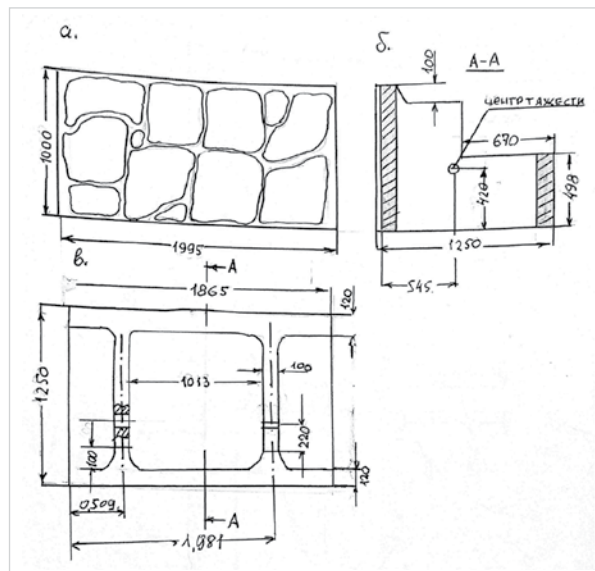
Железобетонный пустотелый блок: а. вид спереди; б. поперечное сечение; в. вид сверху
